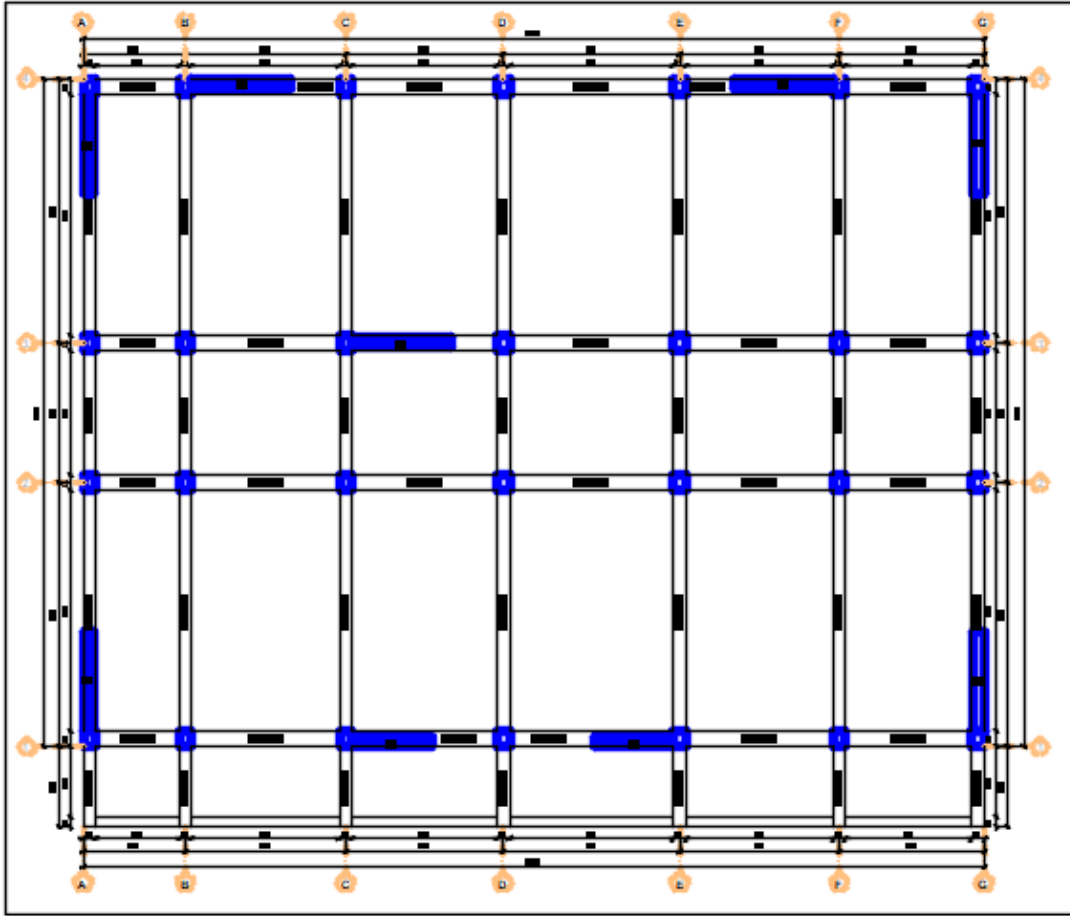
Ubicación de Muros de Corte proyectados para rigidizar la estructura (Módulo C)
